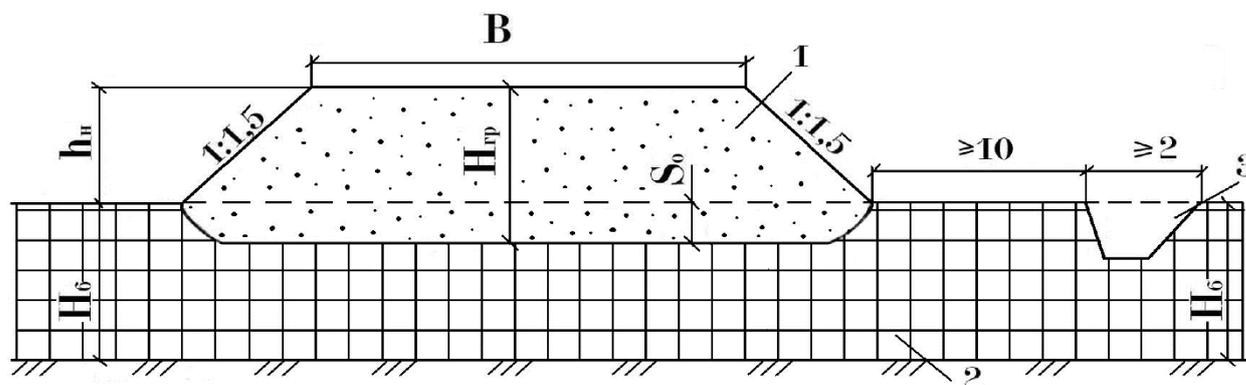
Поперечный профиль насыпи на болотах I, II, III типов: 1 – минеральный грунт; 2 – торфяная залежь; 3 – торфоприемник глубиной до 1 м; S_0 – осадка насыпи
